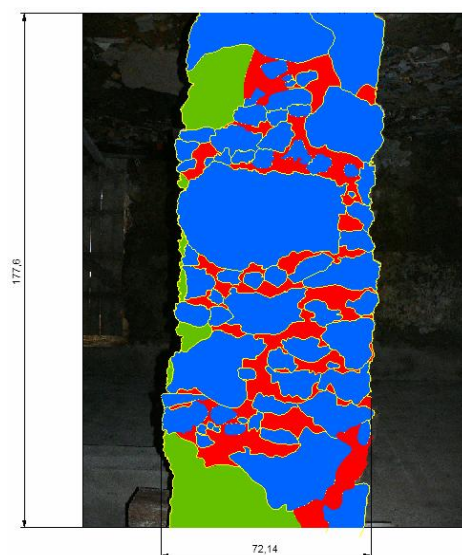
Elementos constituintes da secção transversal da Travessa da Escola Primária - Porto Brandão
